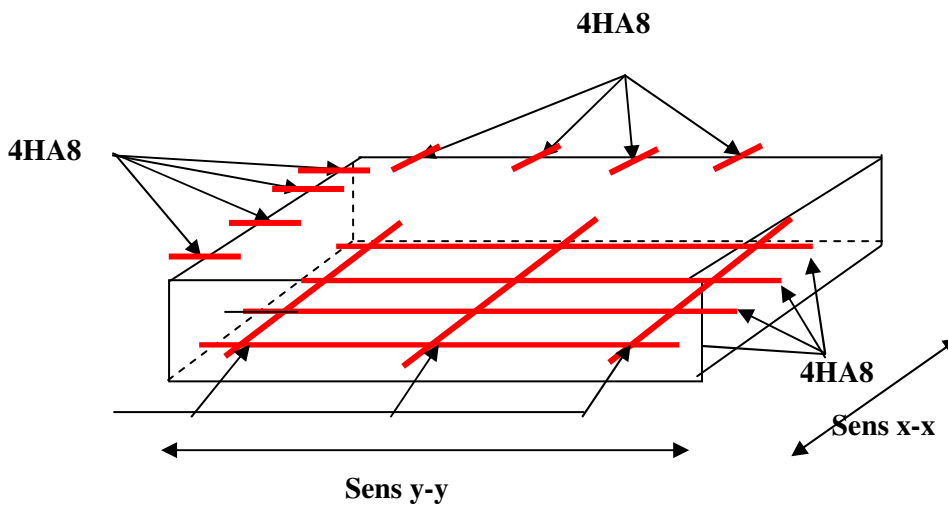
Schéma de ferrailage de la dalle pleine du local machinerie.
